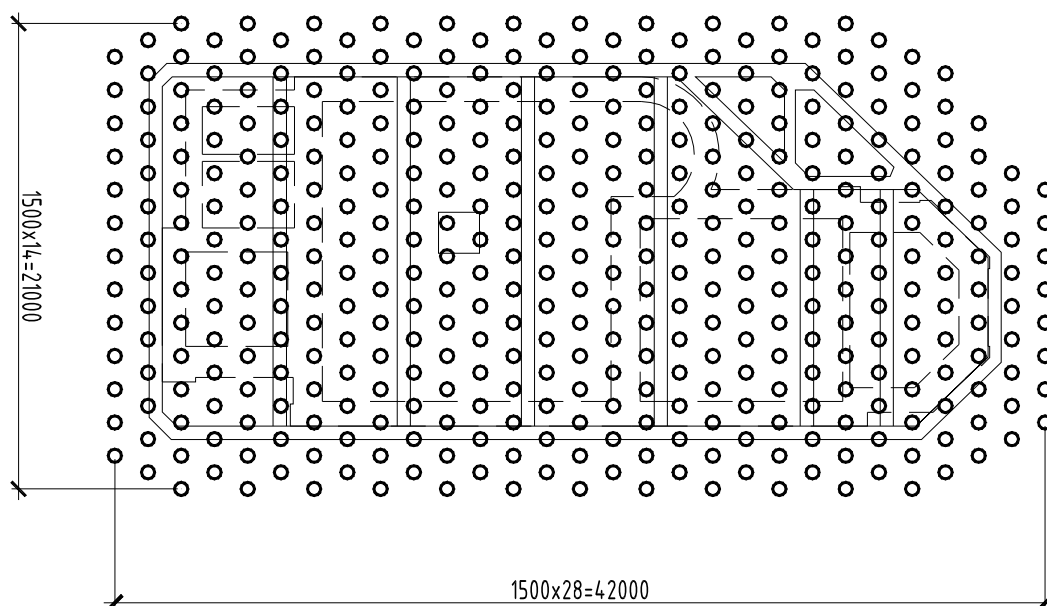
Схема устройства грунтоцементных колонн
